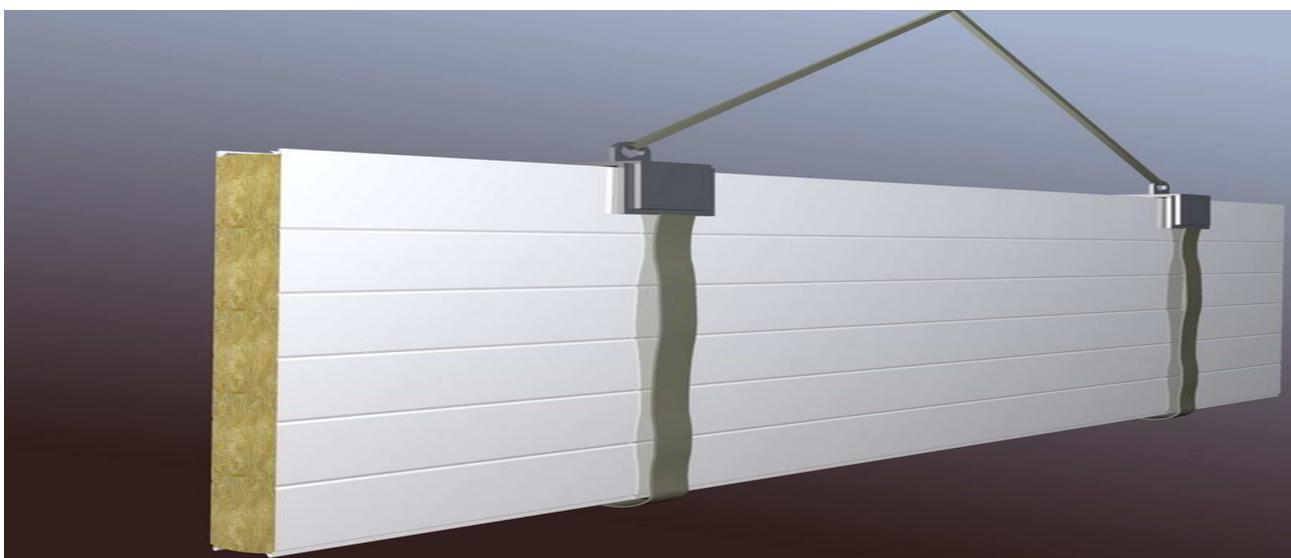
б – Подвеска стеновых панелей при горизонтальном перемещении с помощью управляющего троса
